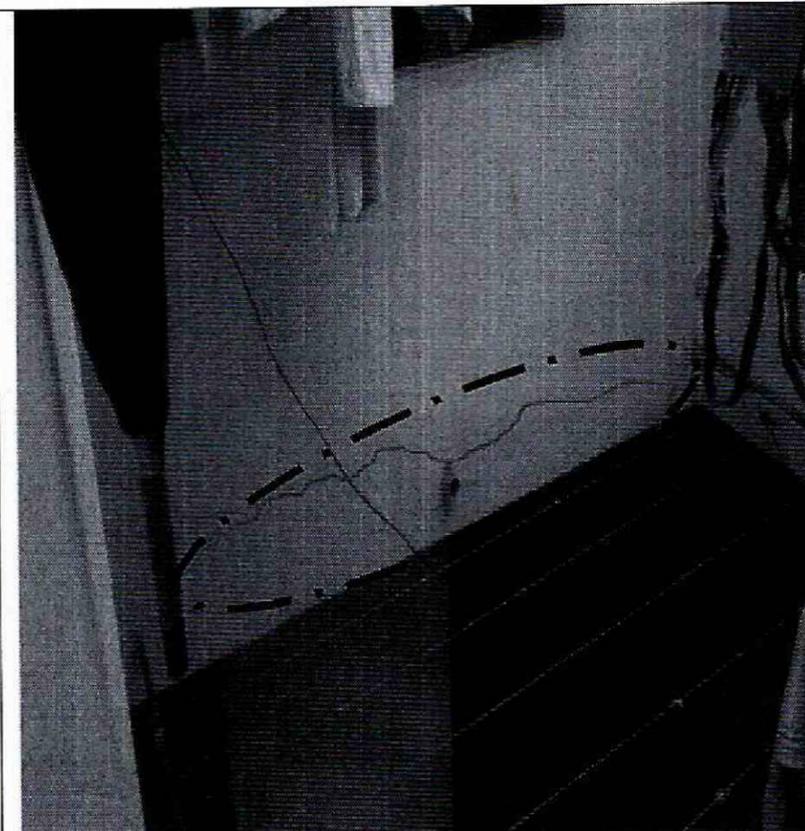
Fisuras identificadas en muros de cerramiento y divisorios en la vivienda de la Calle 137 A No 98 B - 21
